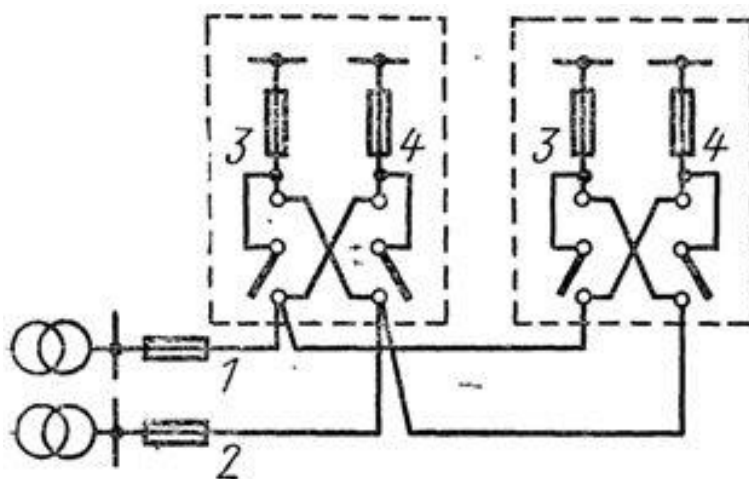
Схема питания жилых домов высотой 9-16 этажей:
